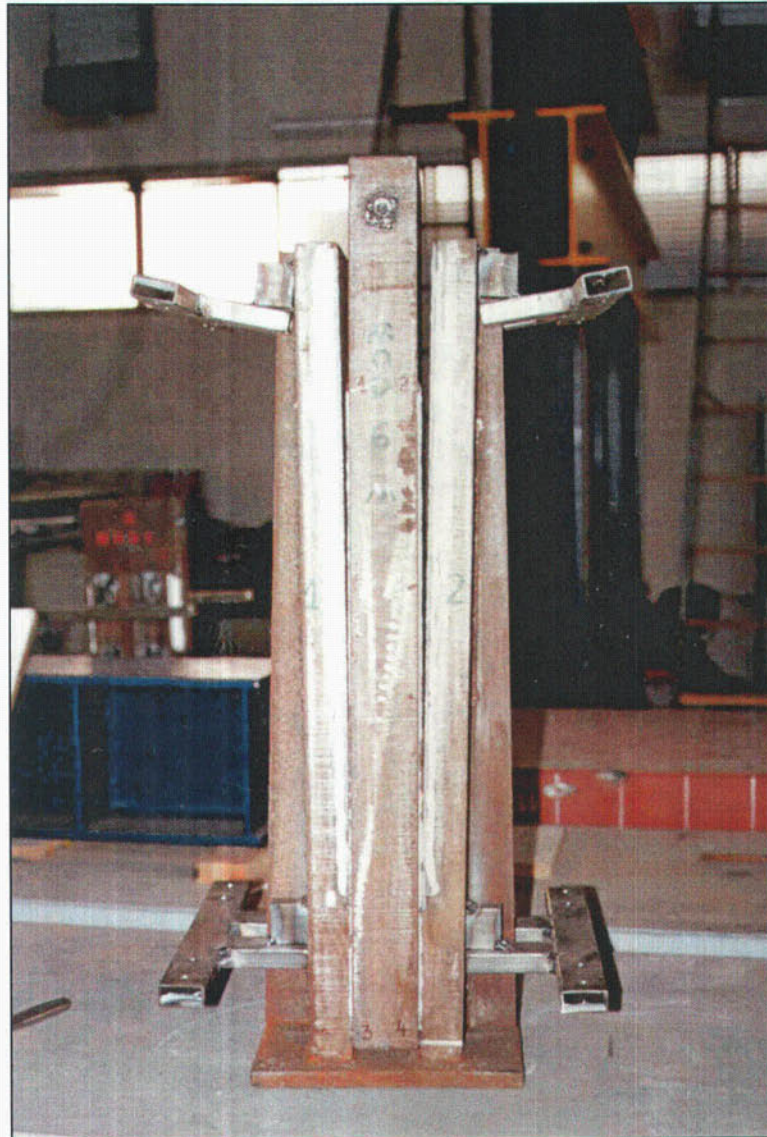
Detalle de la probeta 6M ya rota. Se encuentran completamente arrancadas las soldaduras 1-3 y 2-4. La rotura nuevamente se produce por la sección de garganta de las soldaduras.
